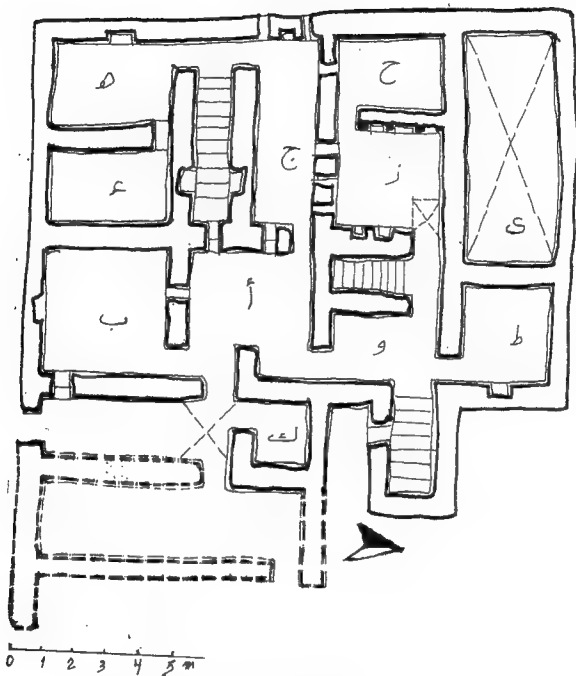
منزل القاضي عمر الدور الأرضي - مسقط أفقي
